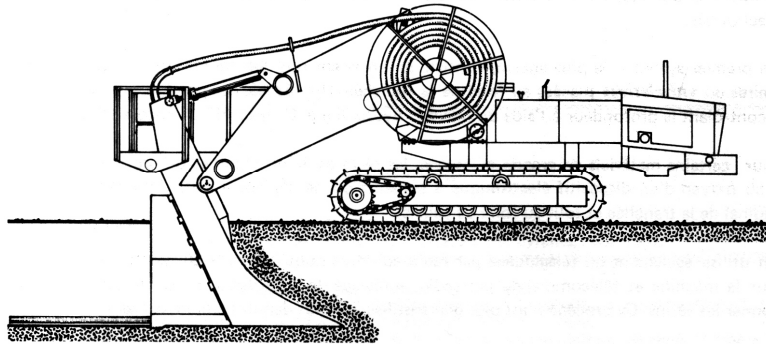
Assentador automotriz com dispositivo escavador para colocação de condutas plásticas de drenagem.
